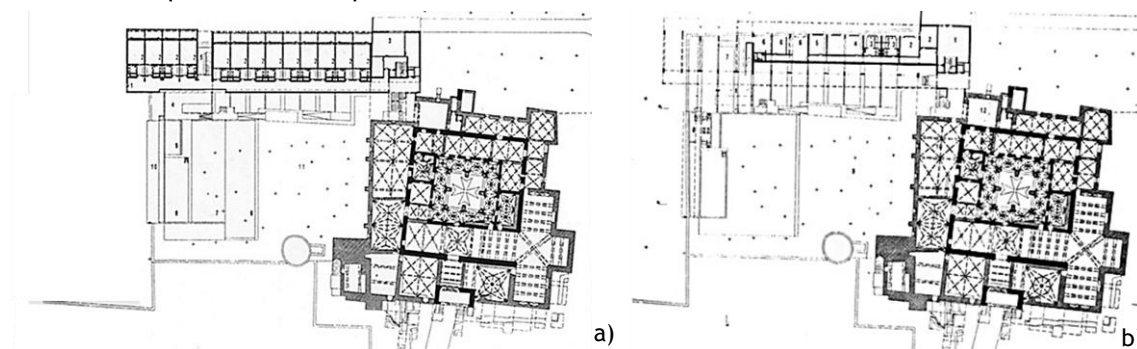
Mosteiro da Flor da Rosa depois das obras de restauro.
